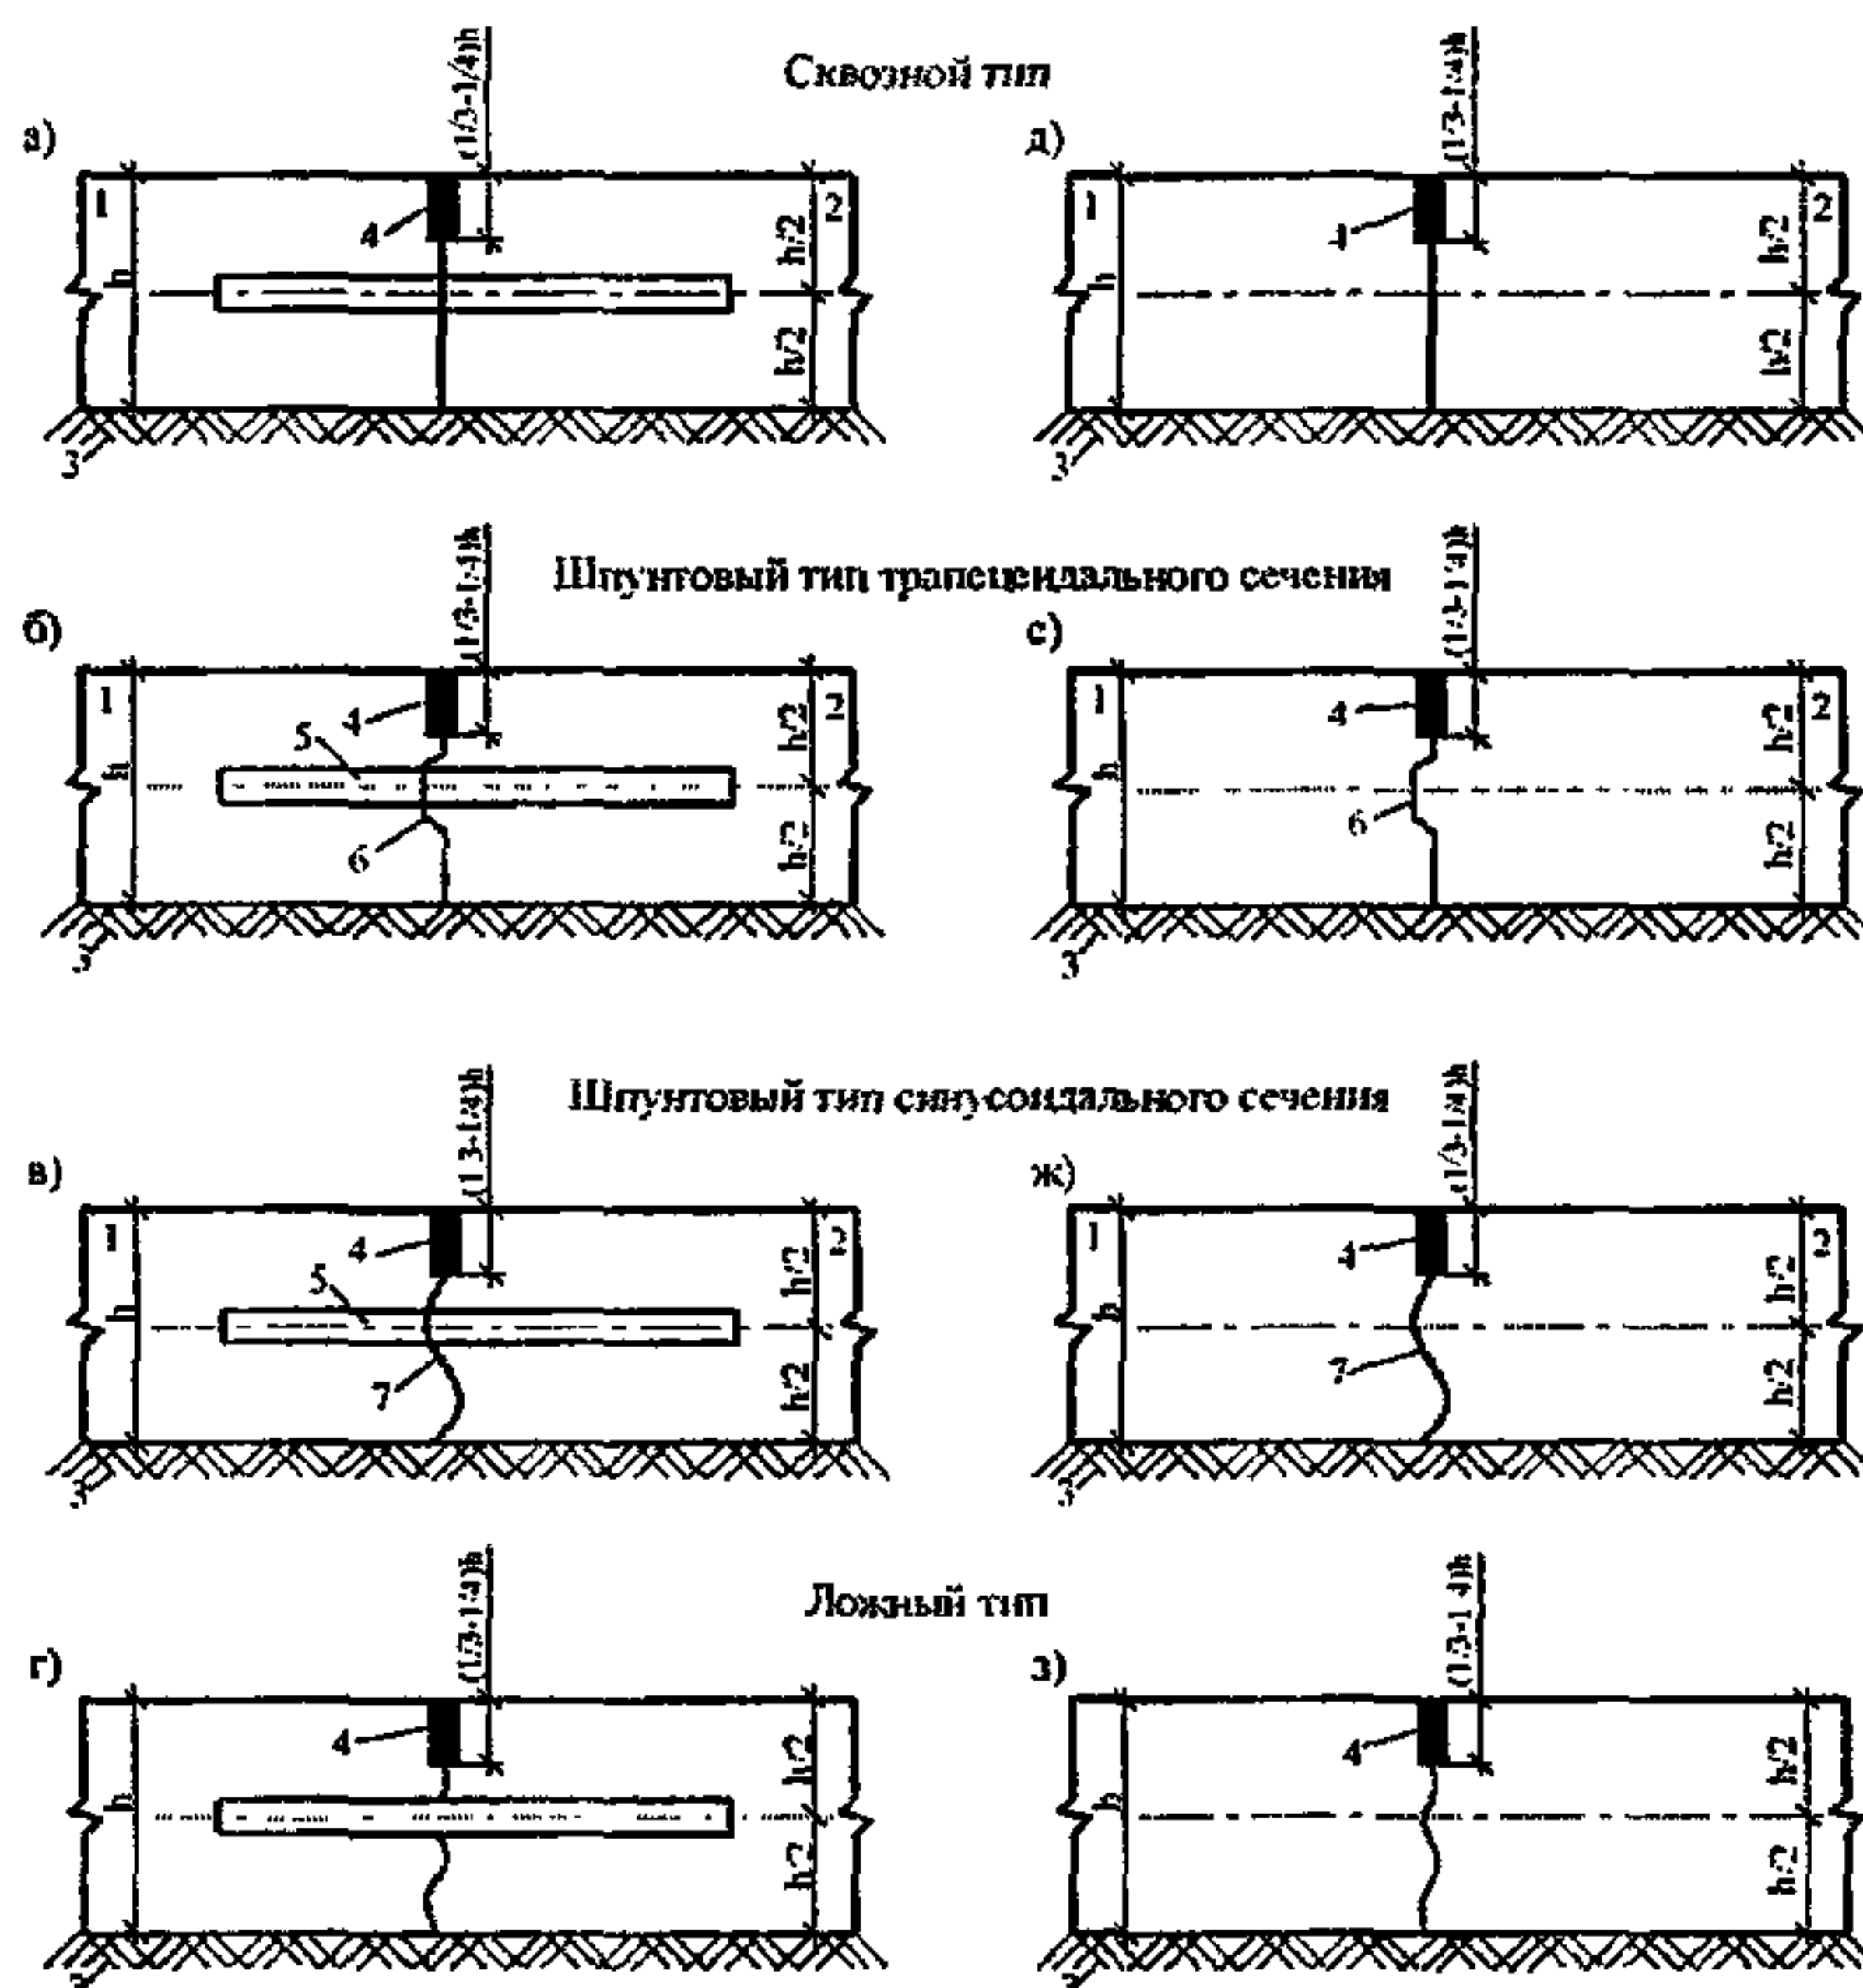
Схема расположения швов на цементобетонном покрытии
